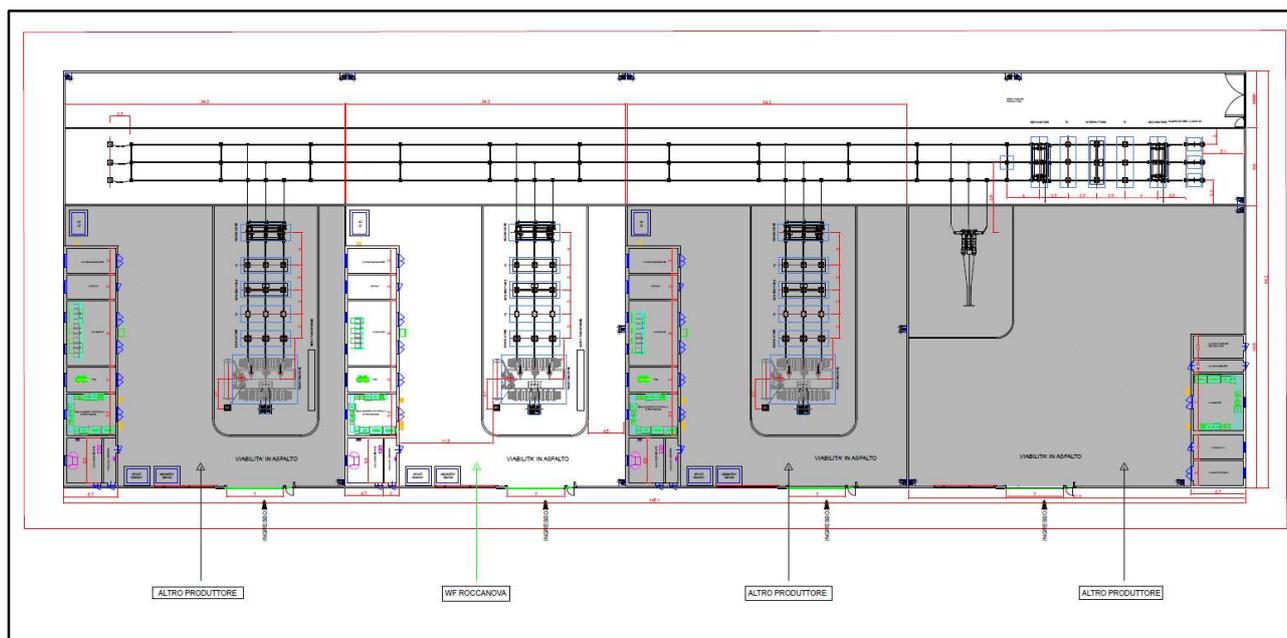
Layout della Stazione Elettrica Utente 150/33 kV (SEU)
